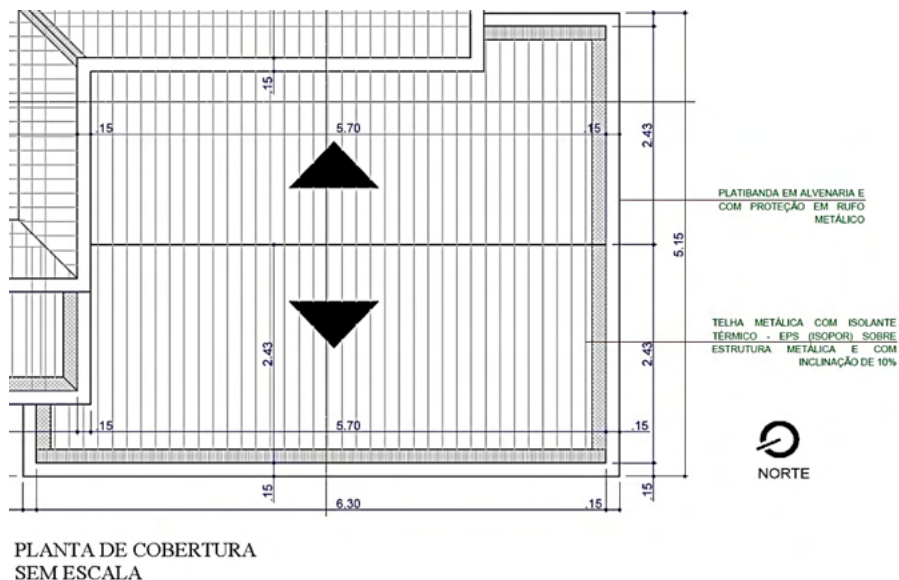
Parte do projeto arquitetônico da cobertura em telha metálica com queda em duas águas e platibanda.
